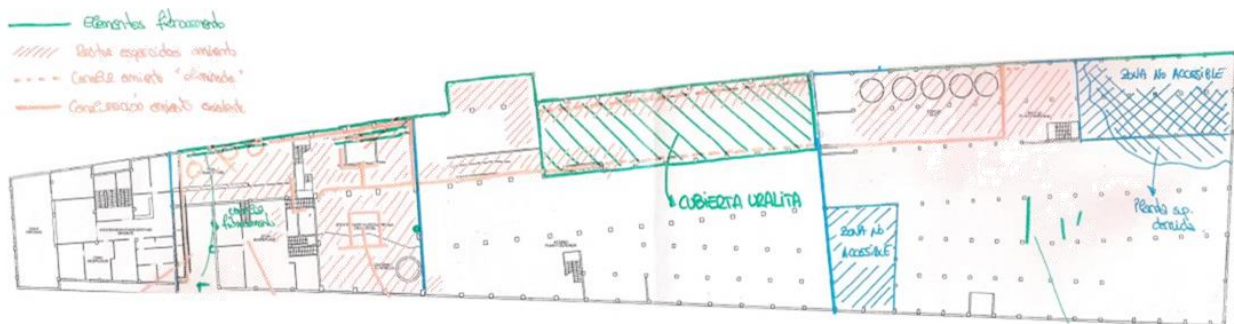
Interior de la fábrica: planta baja (lado norte) del pabellón central junto a la carretera (zona río) en 2015. (Elaboración propia)
